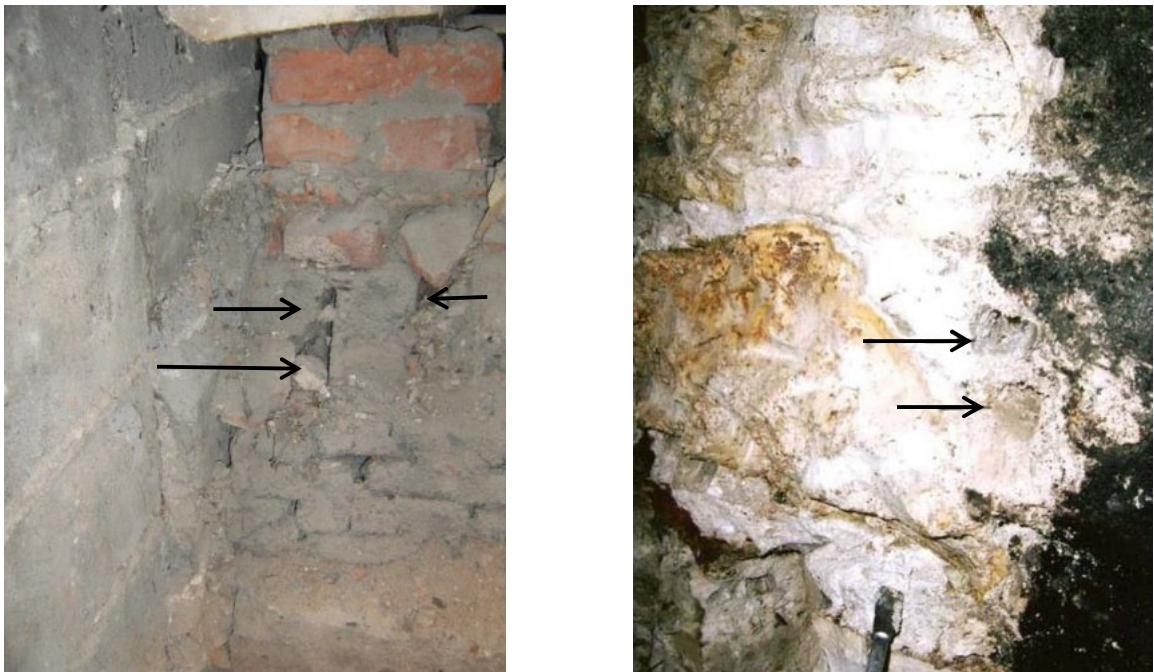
Разрушение материалов фундаментов: а) разрушение кладки фундамента здания (Ср. Кисловский, д.3, стр. 2); б) выщелоченный доломитовый известняк кладки фундамента Храма Всех Святых на Кулишках (фото Беловой Г.С.) (стрелками показаны зоны деструкции фундаментов)
